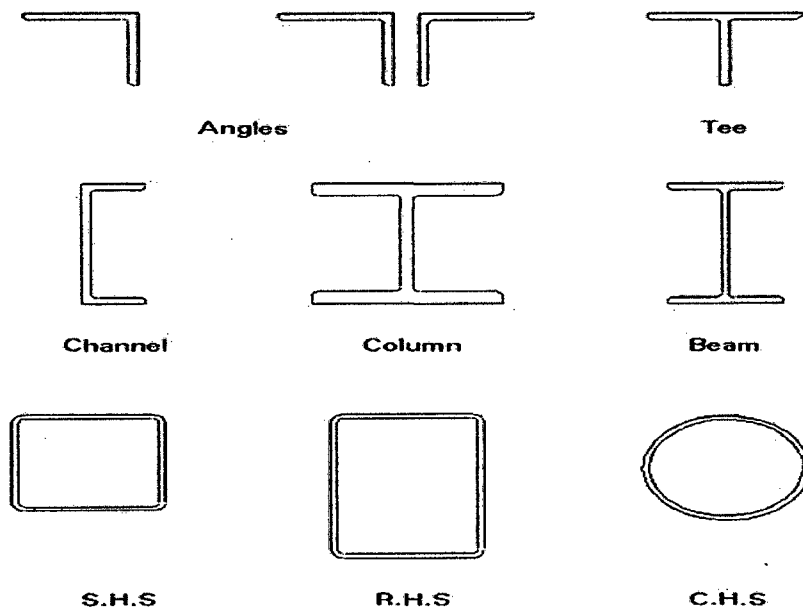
Tipos de secciones transversales de acero. (Referencia, José Agudelo Bravo-2013, Metallic structure, 34P).
